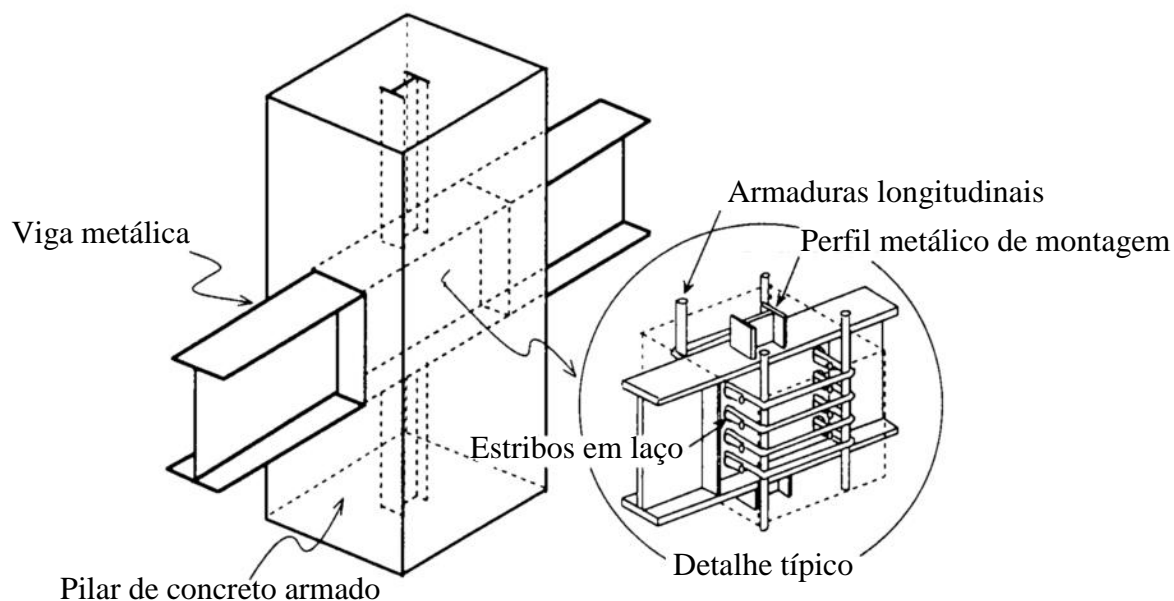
Ligação entre viga metálica e pilar misto de aço e concreto [GRIFFIS (1992)]
